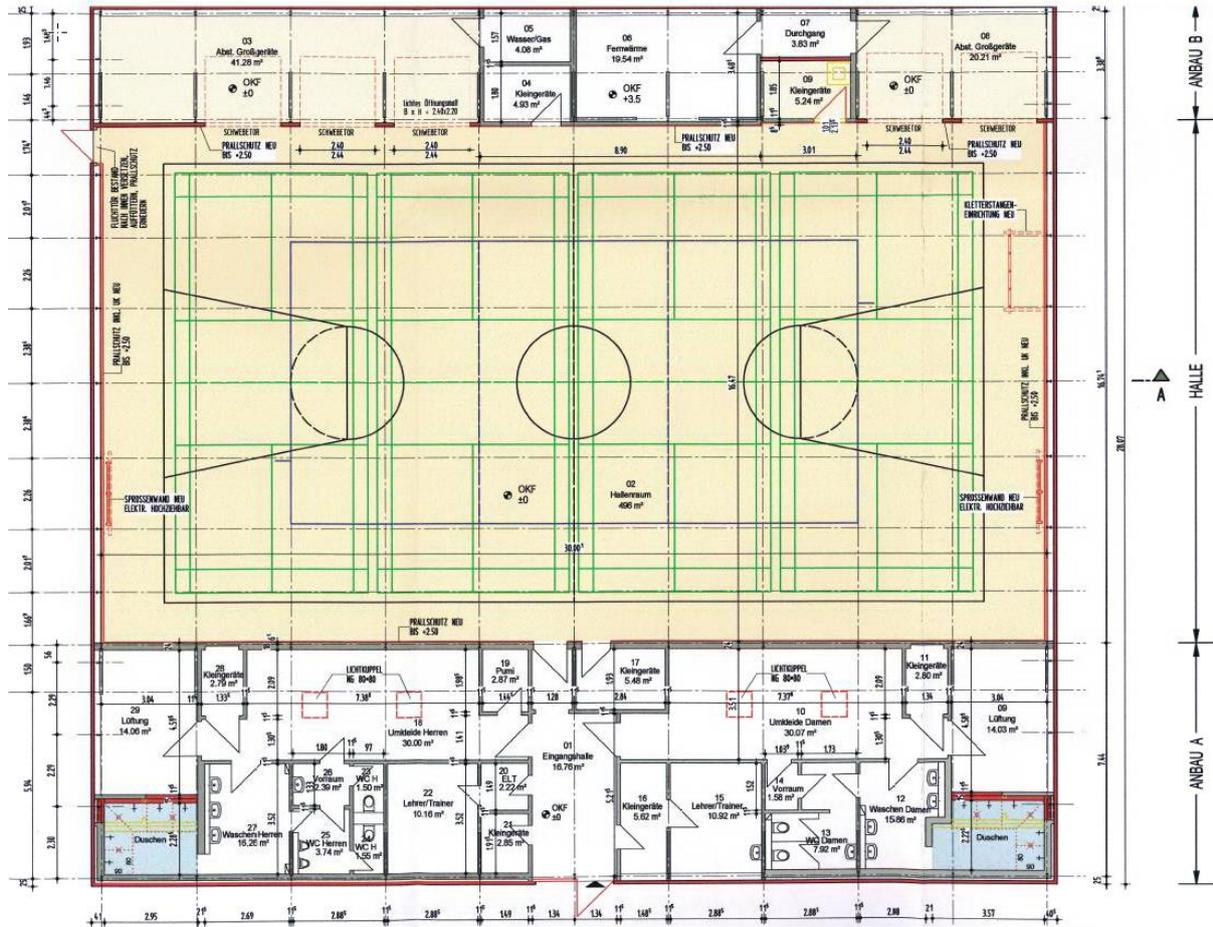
Grundriss TH 12 - Typ KT 60L (Quelle: ZGM)
